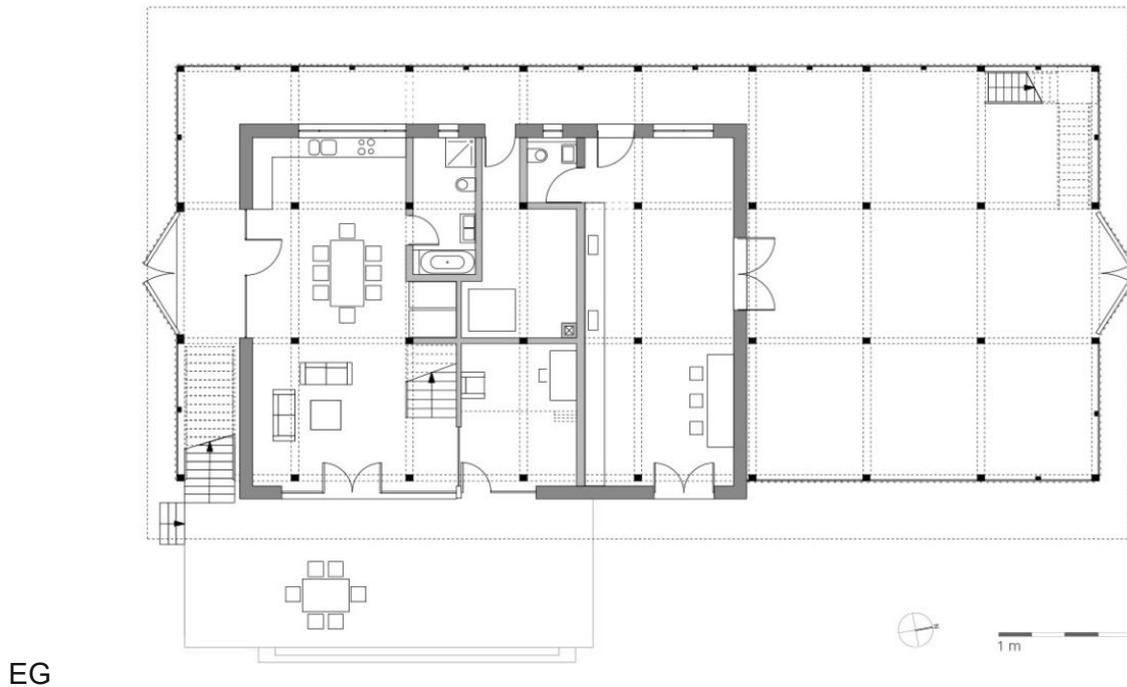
, 49: Grundrisse Torfremise ¹⁰⁶
